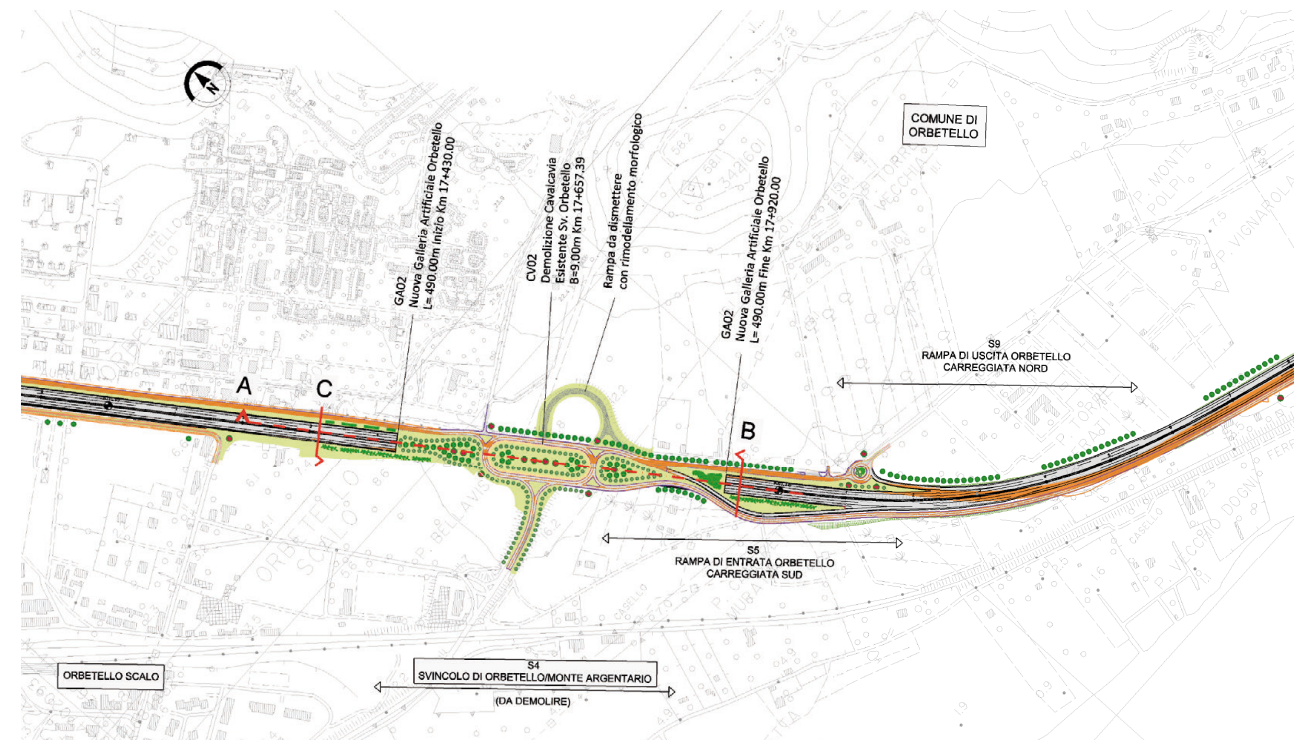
Planimetria opere a verde Orbetello GA02
